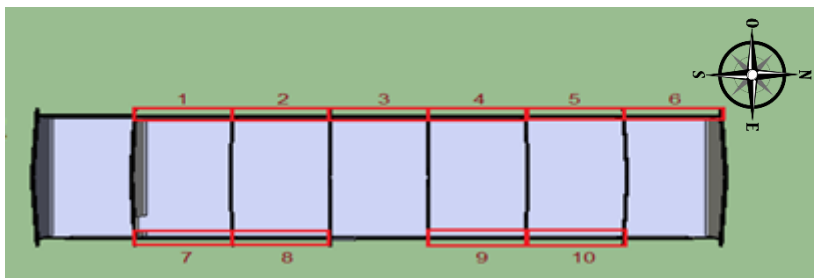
10 Paredes a ser afectadas con el aumento de 90cm en la mampostería.
